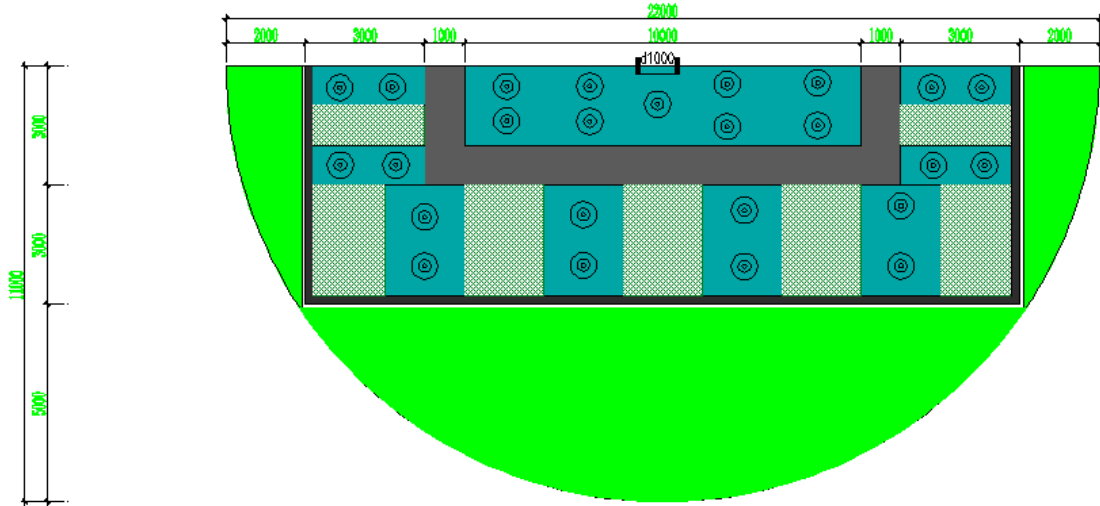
雨水排水口生态拦截设施工艺平面图
